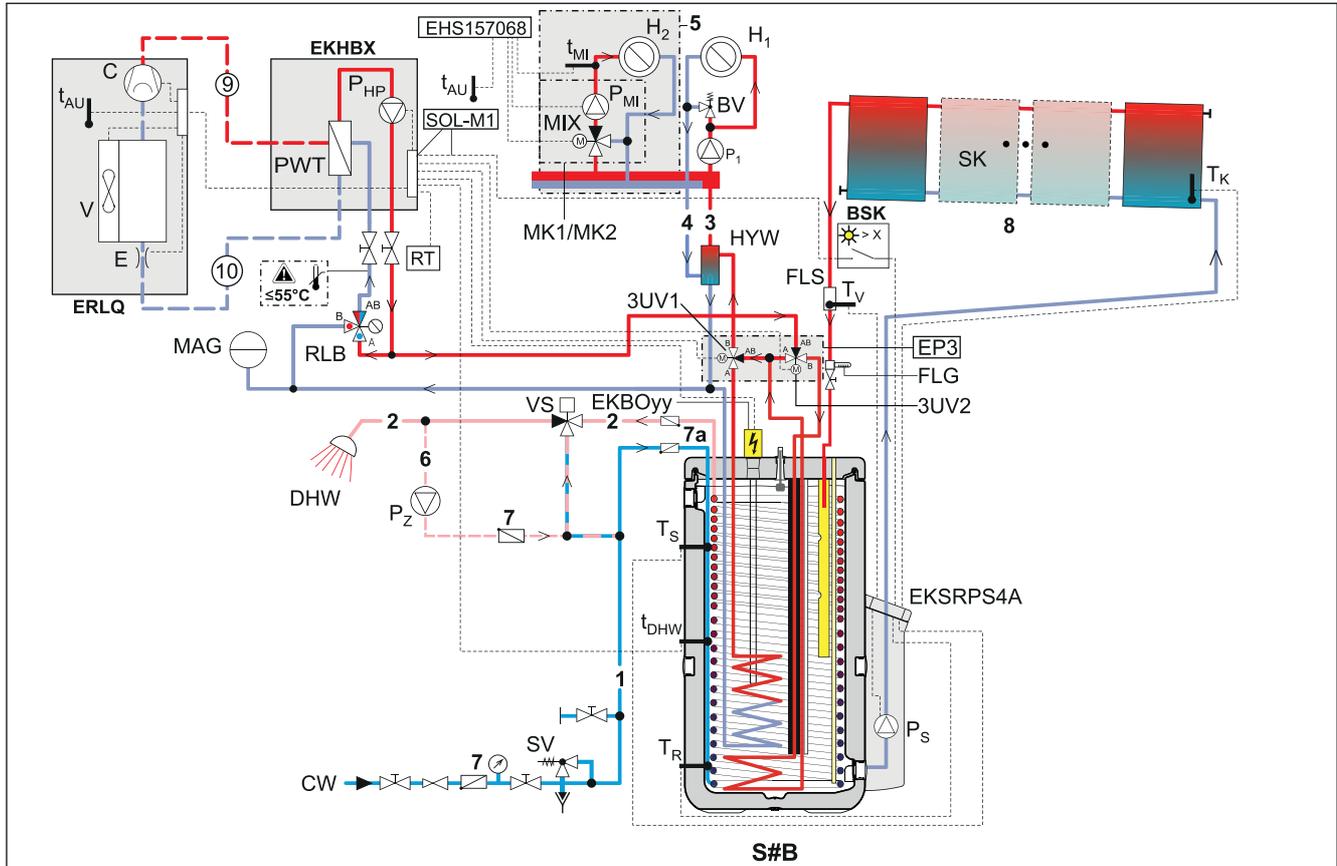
Schema di collegamento standard con pompa di calore e DrainBack Solar¹⁾ $p=0$ (rappresentato nella versione con solo funzione di riscaldamento ambiente)¹⁾ (vedere legenda tab. 6-1)
